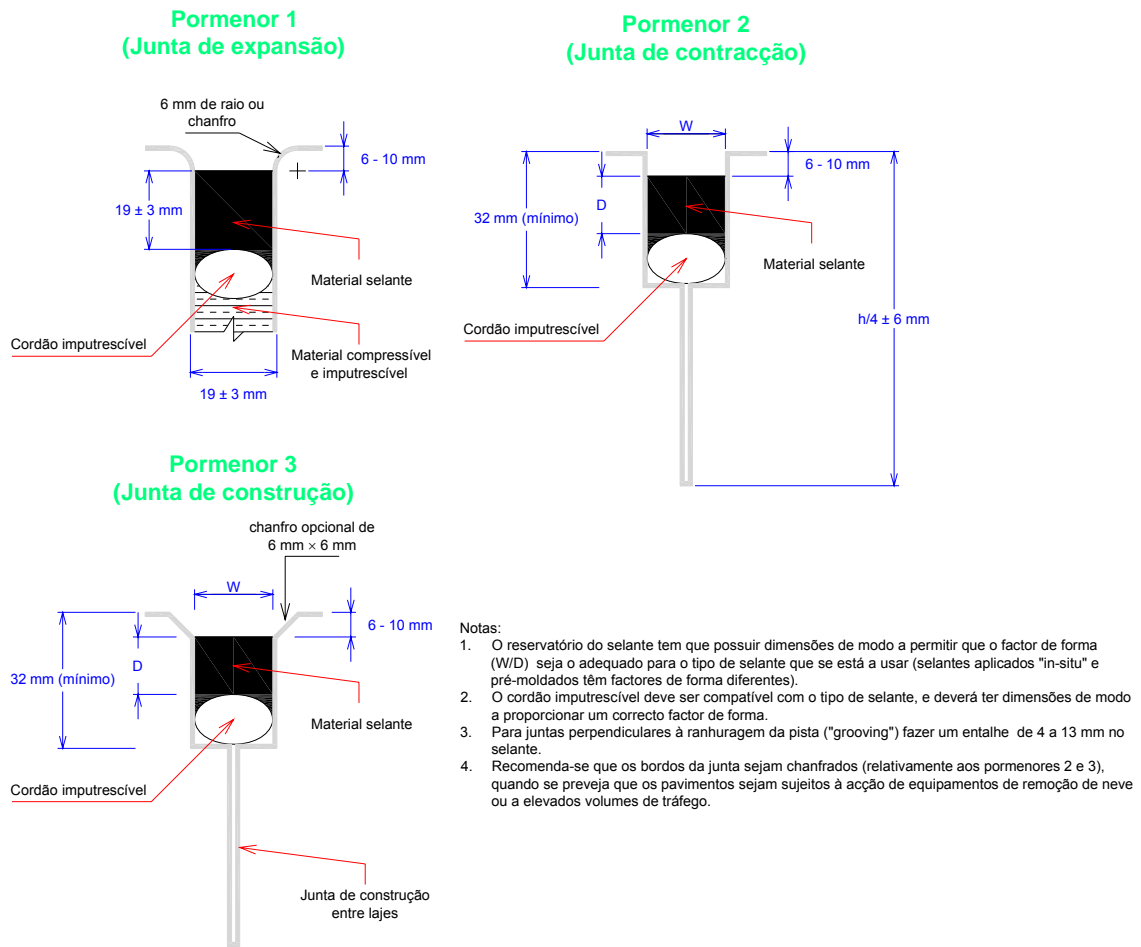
Pormenores da selagem de juntas em pavimentos rígidos
